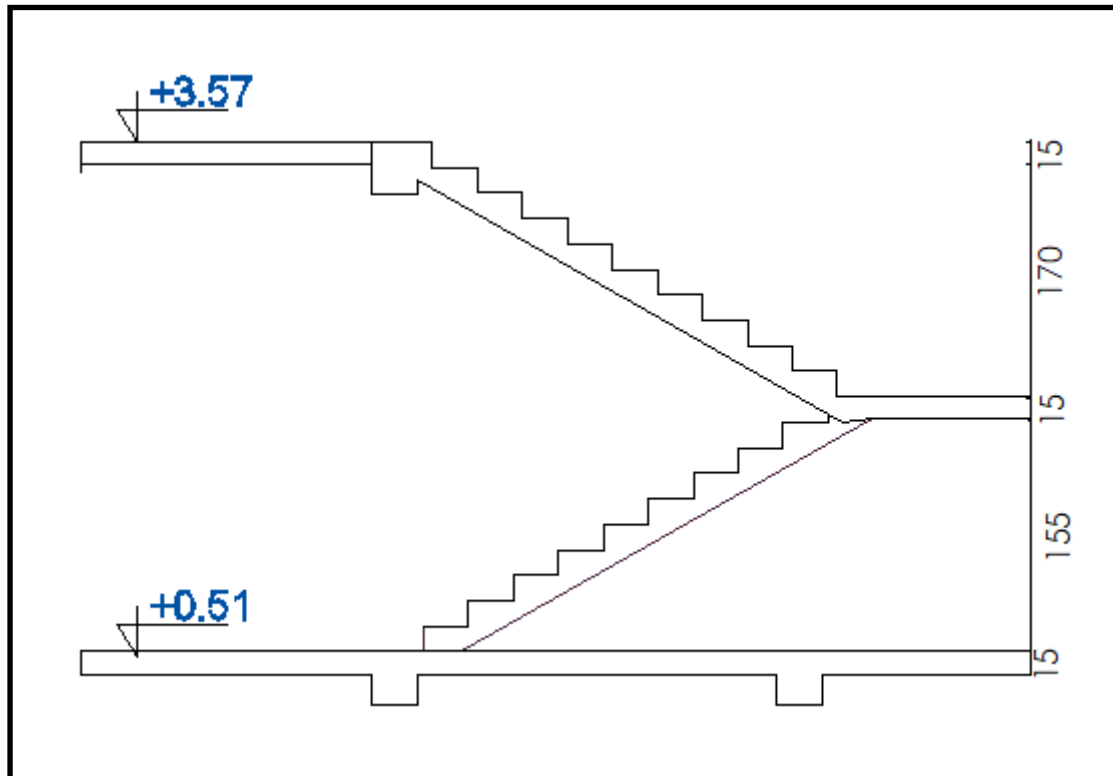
schématisation des escaliers faite avec l'AUTOCAD
